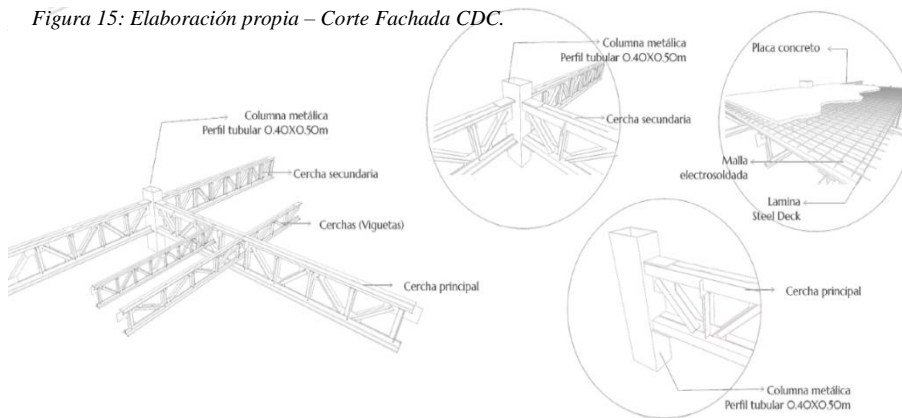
Elaboración propia – Detalle de sistema estructural y uniones.
